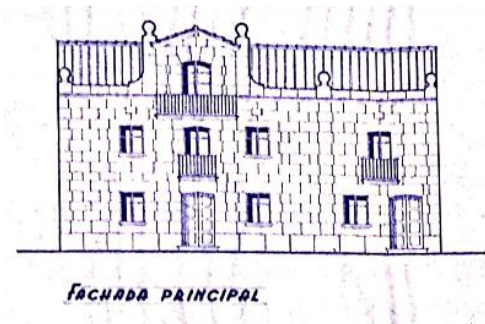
Alzado principal del Centro Rural de higiene y vivienda para medio
